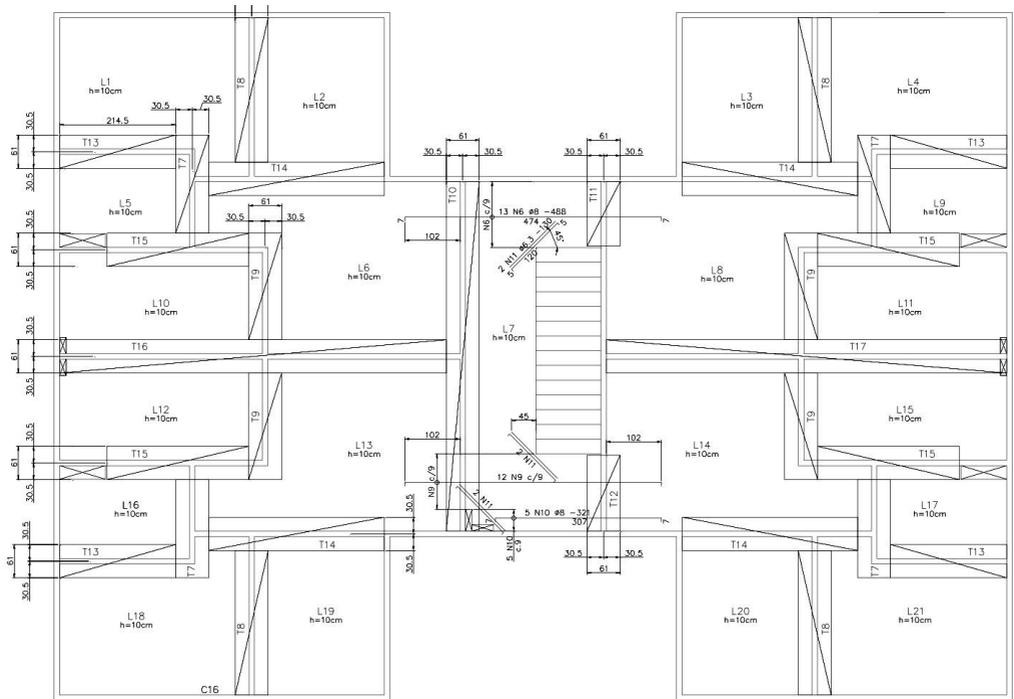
Planta armação superior (negativa) de laje – pavimentos 1 a 4 (x4).
